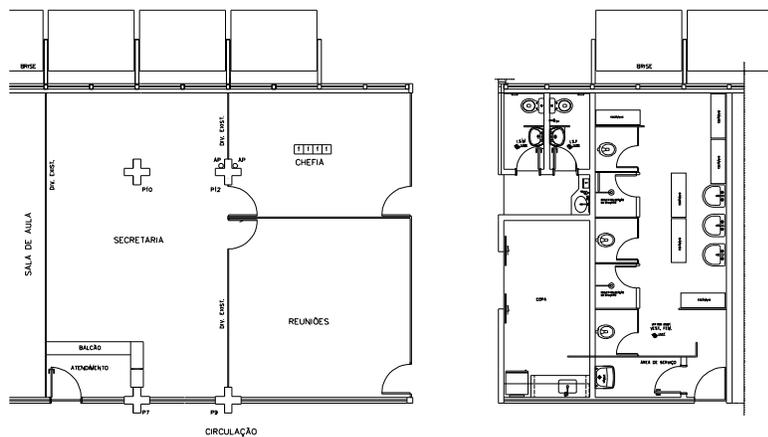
Planta modificação sanitário e secretaria – segundo pavimento
